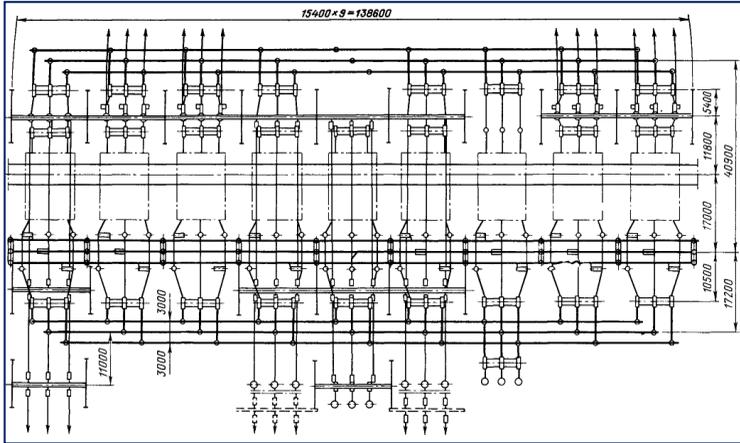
План ОРУ 220 кВ по схеме две рабочие и обходная системы шин
